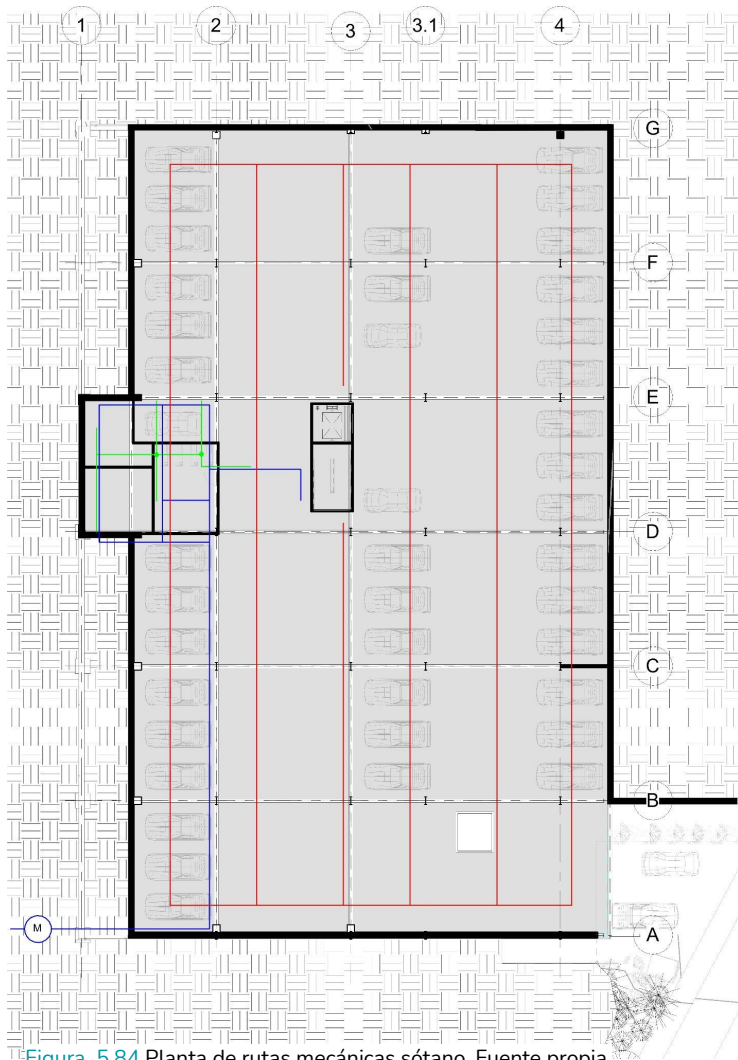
Planta de rutas mecánicas sótano. Fuente propia.
